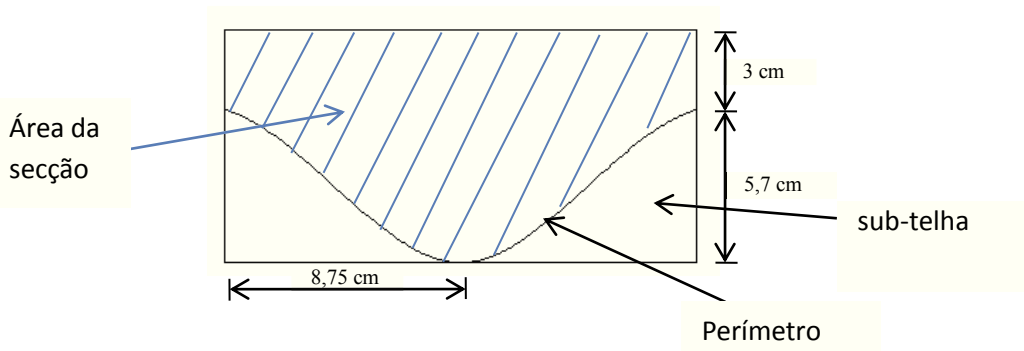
Secção transversal do canal da caixa-de-ar.
